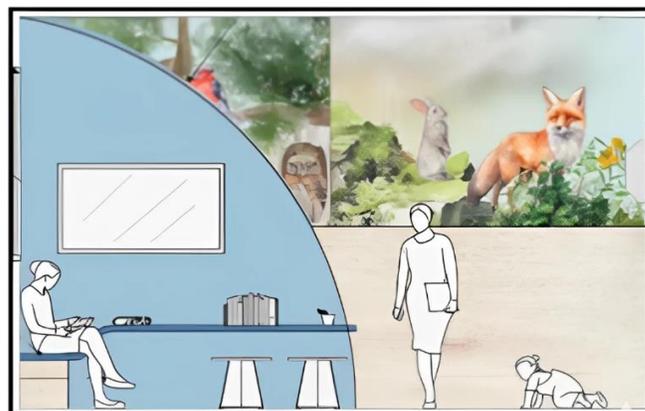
Elevación de detalle arquitectónico y materialidad.
